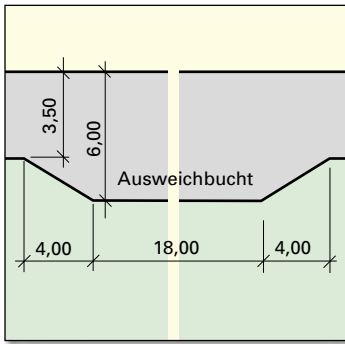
Baustellenerschließung mit einer Ausweichbucht
